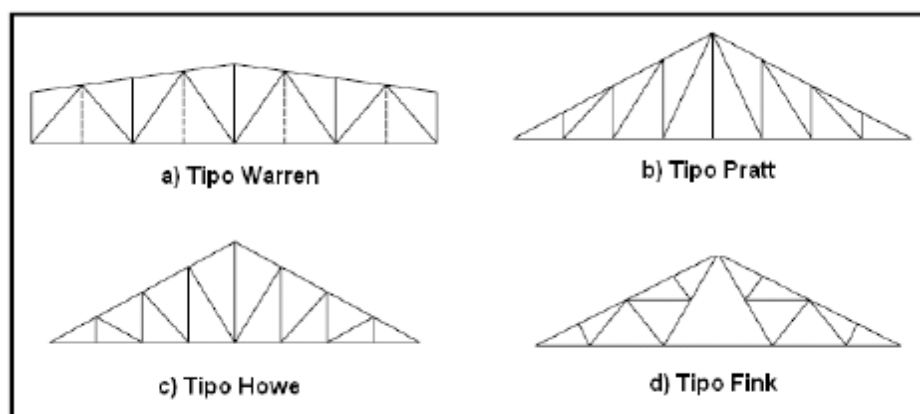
Armaduras comunes en cubiertas (Ramirez, 2013)
